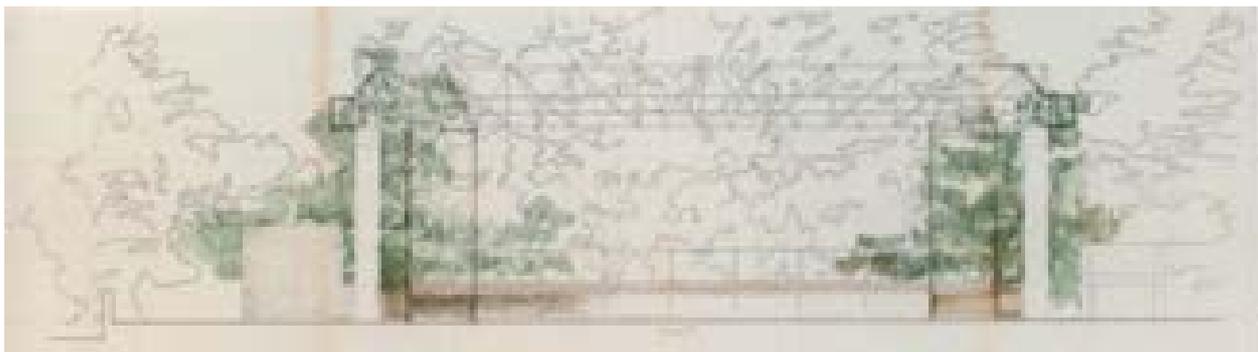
Prospetto sud, stato futuro – opere di completamento – 11/06/1997 (AABS-623)
